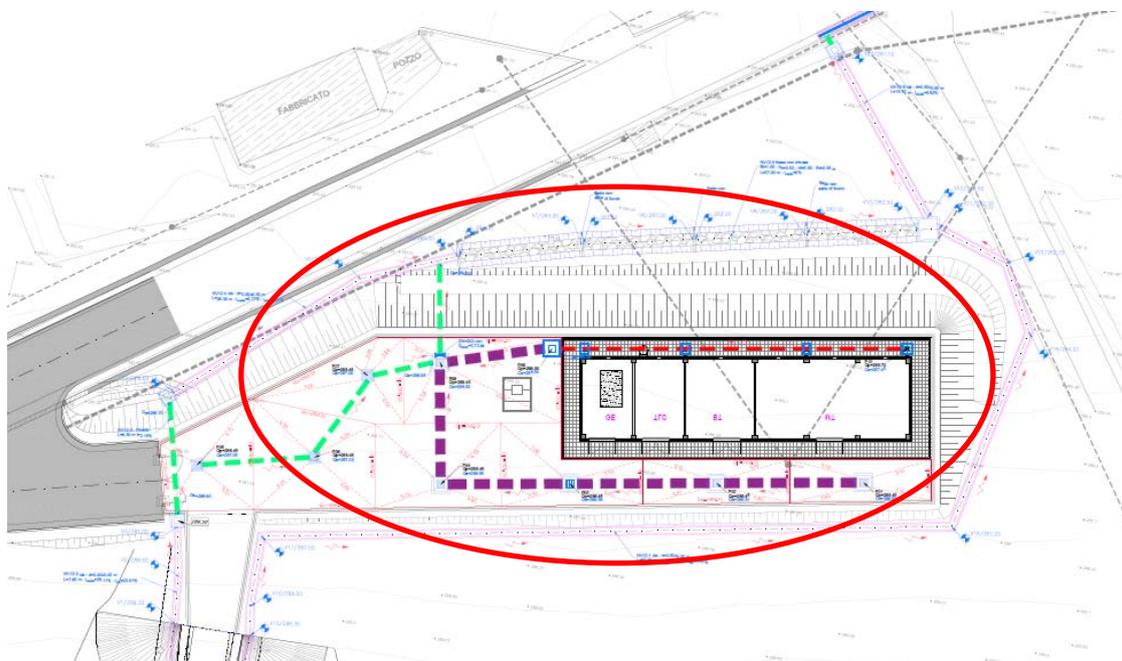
Planimetria della sistemazione del piazzale RI58 come da prescrizione in oggetto
